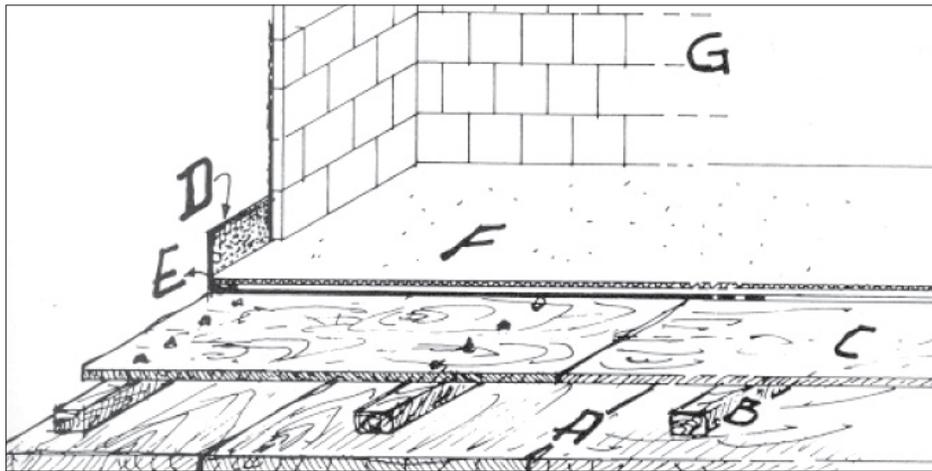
Alzado del piso de un solar en madera para su ventilación.
